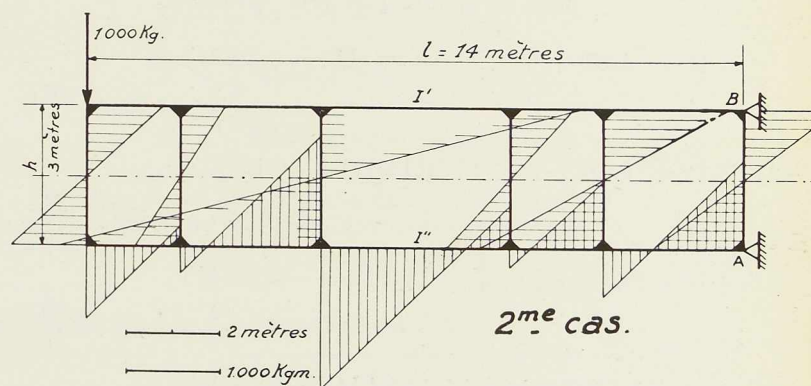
Une poutre de hauteur constante en porte-à-faux, attachée par deux rotules A et B.
